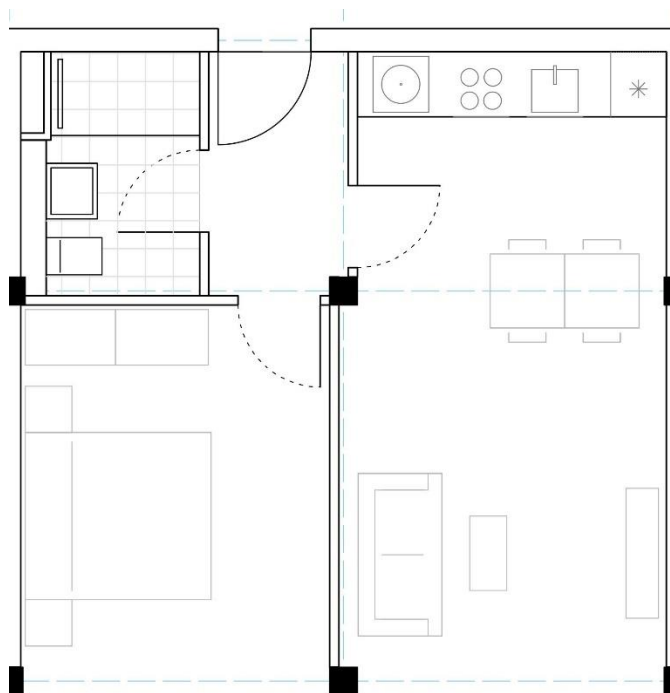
Beispiel für einen Wohnungsgrundriss mit 2 Zimmern [68]
